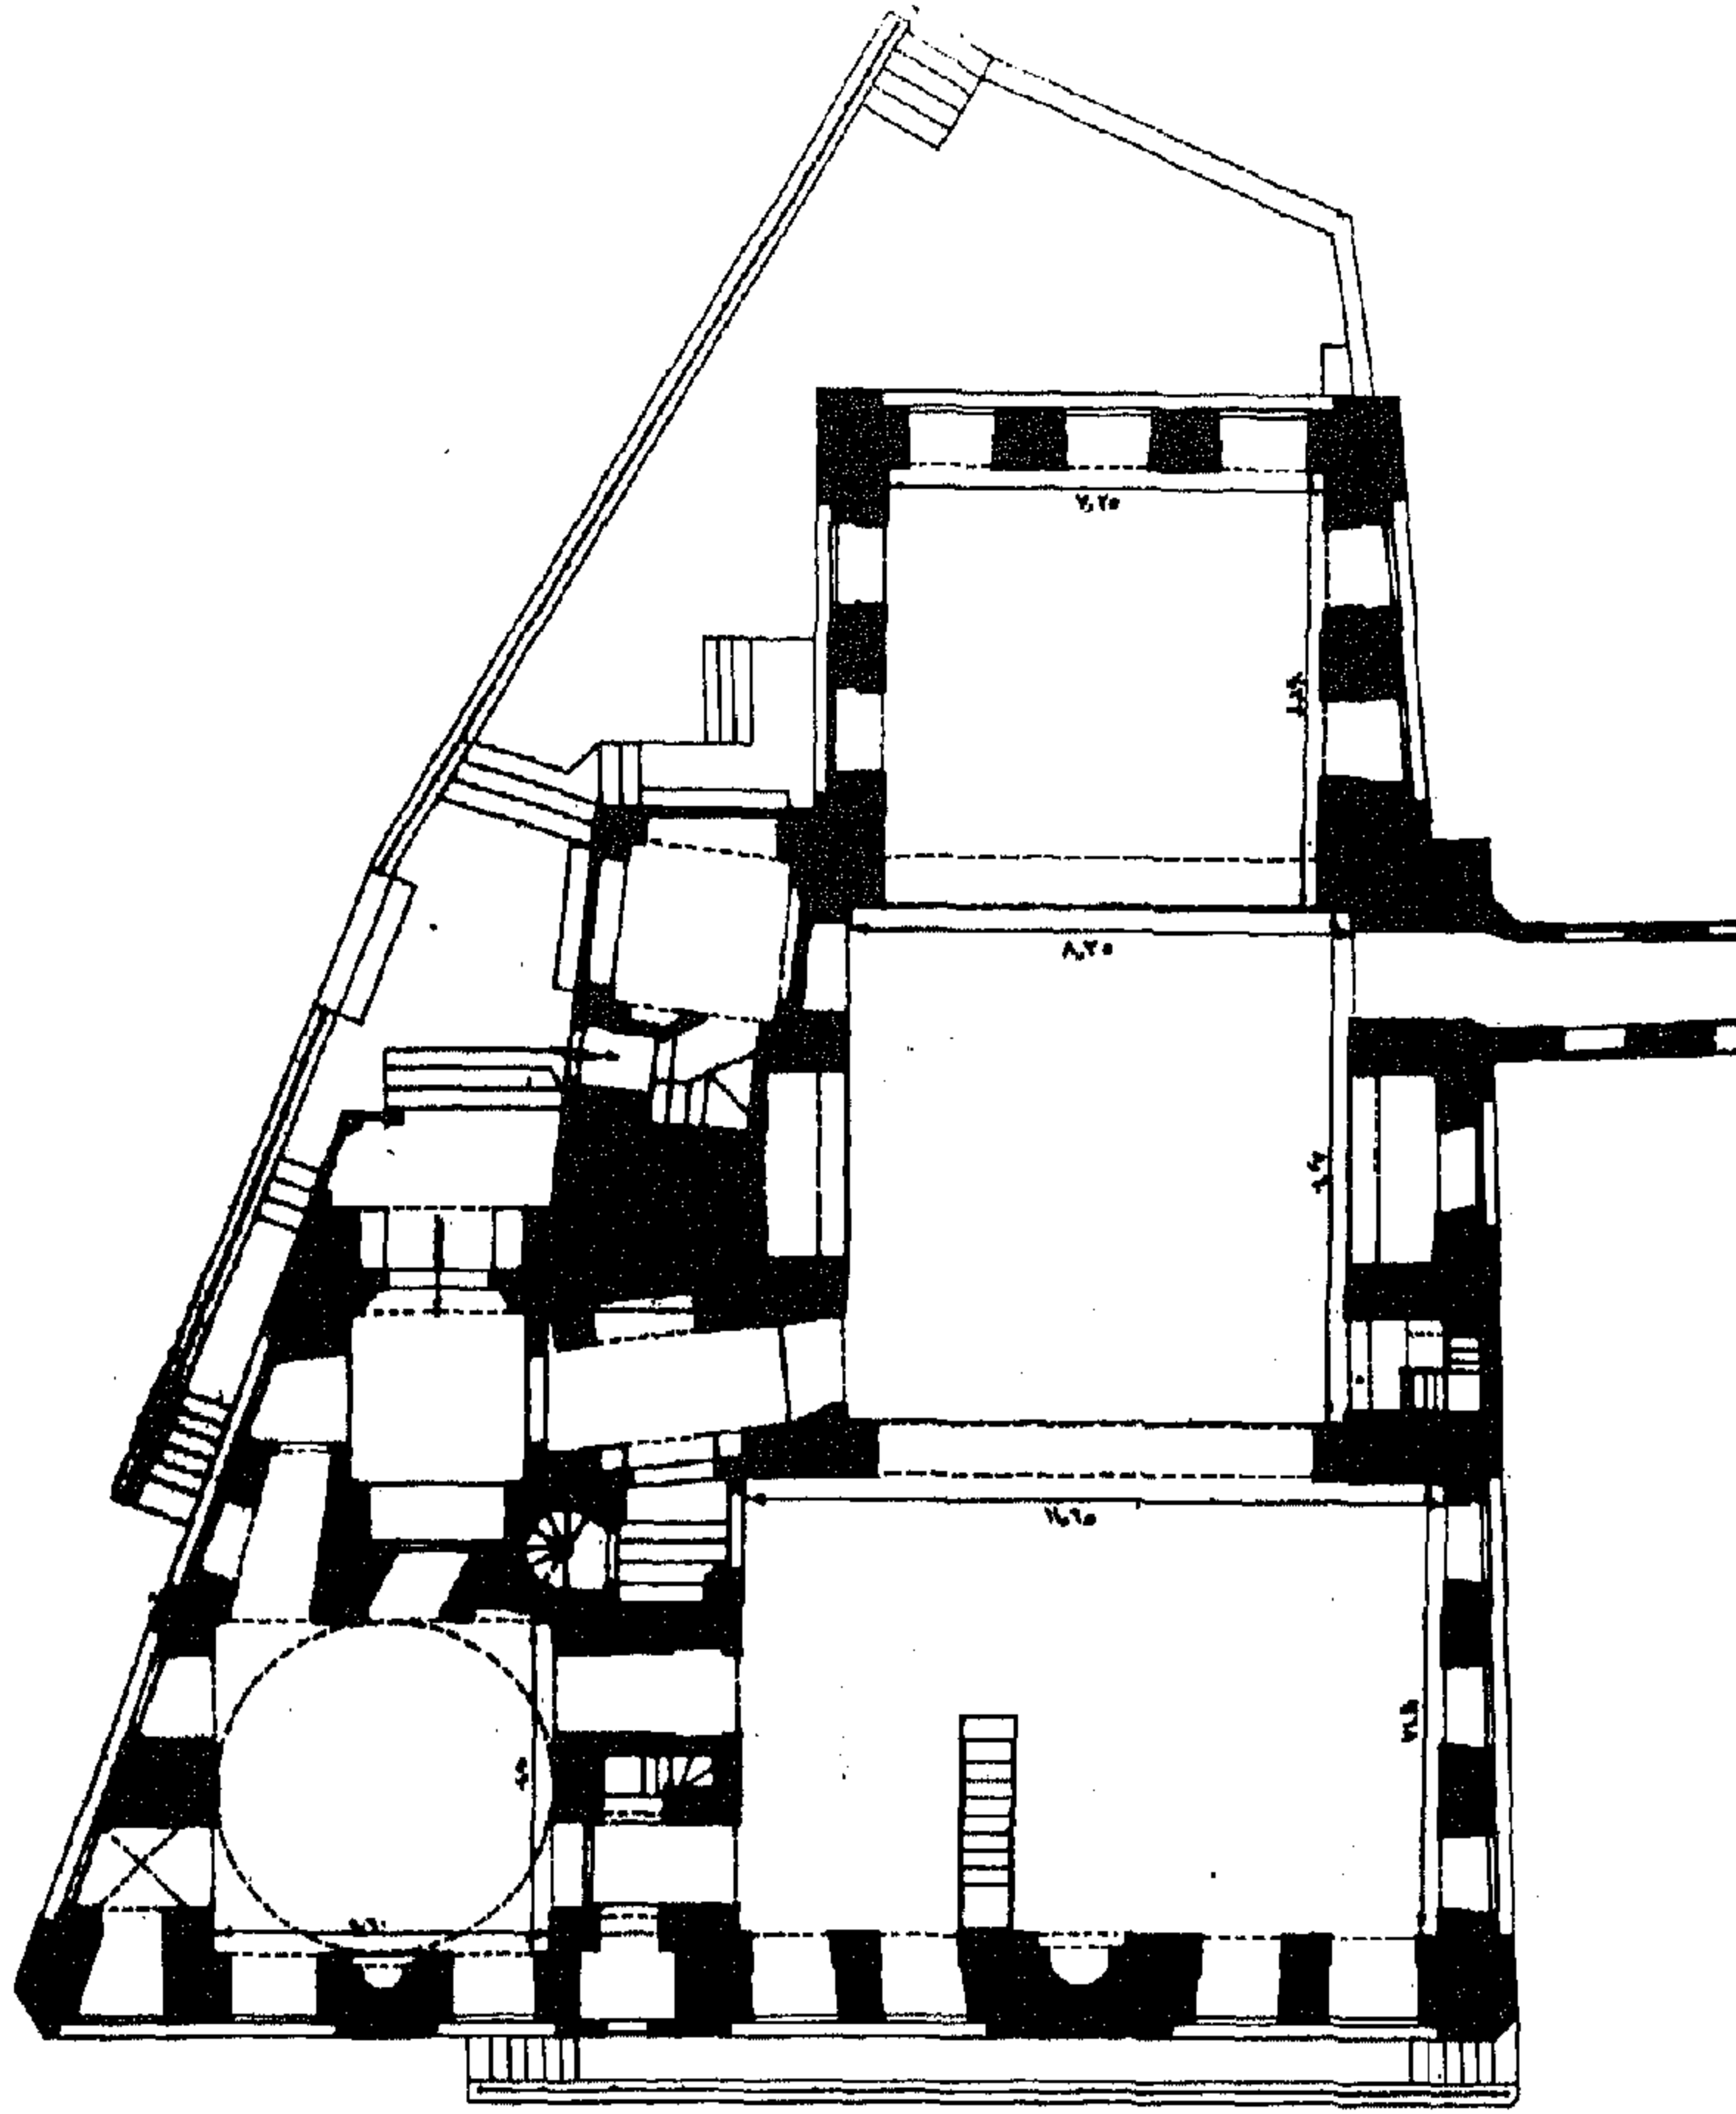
مسقط أفقي لمسجد السلطان برقوق
